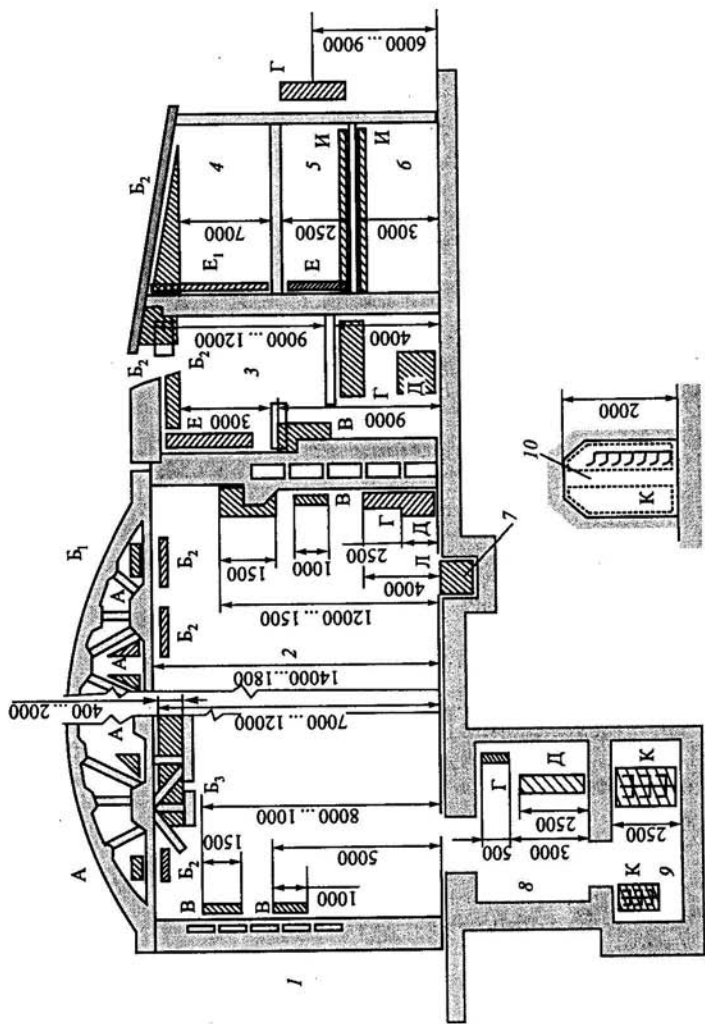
Электротехнические зоны, рекомендуемые для размещения оборудования электрических сетей в зданиях и сооружениях:
